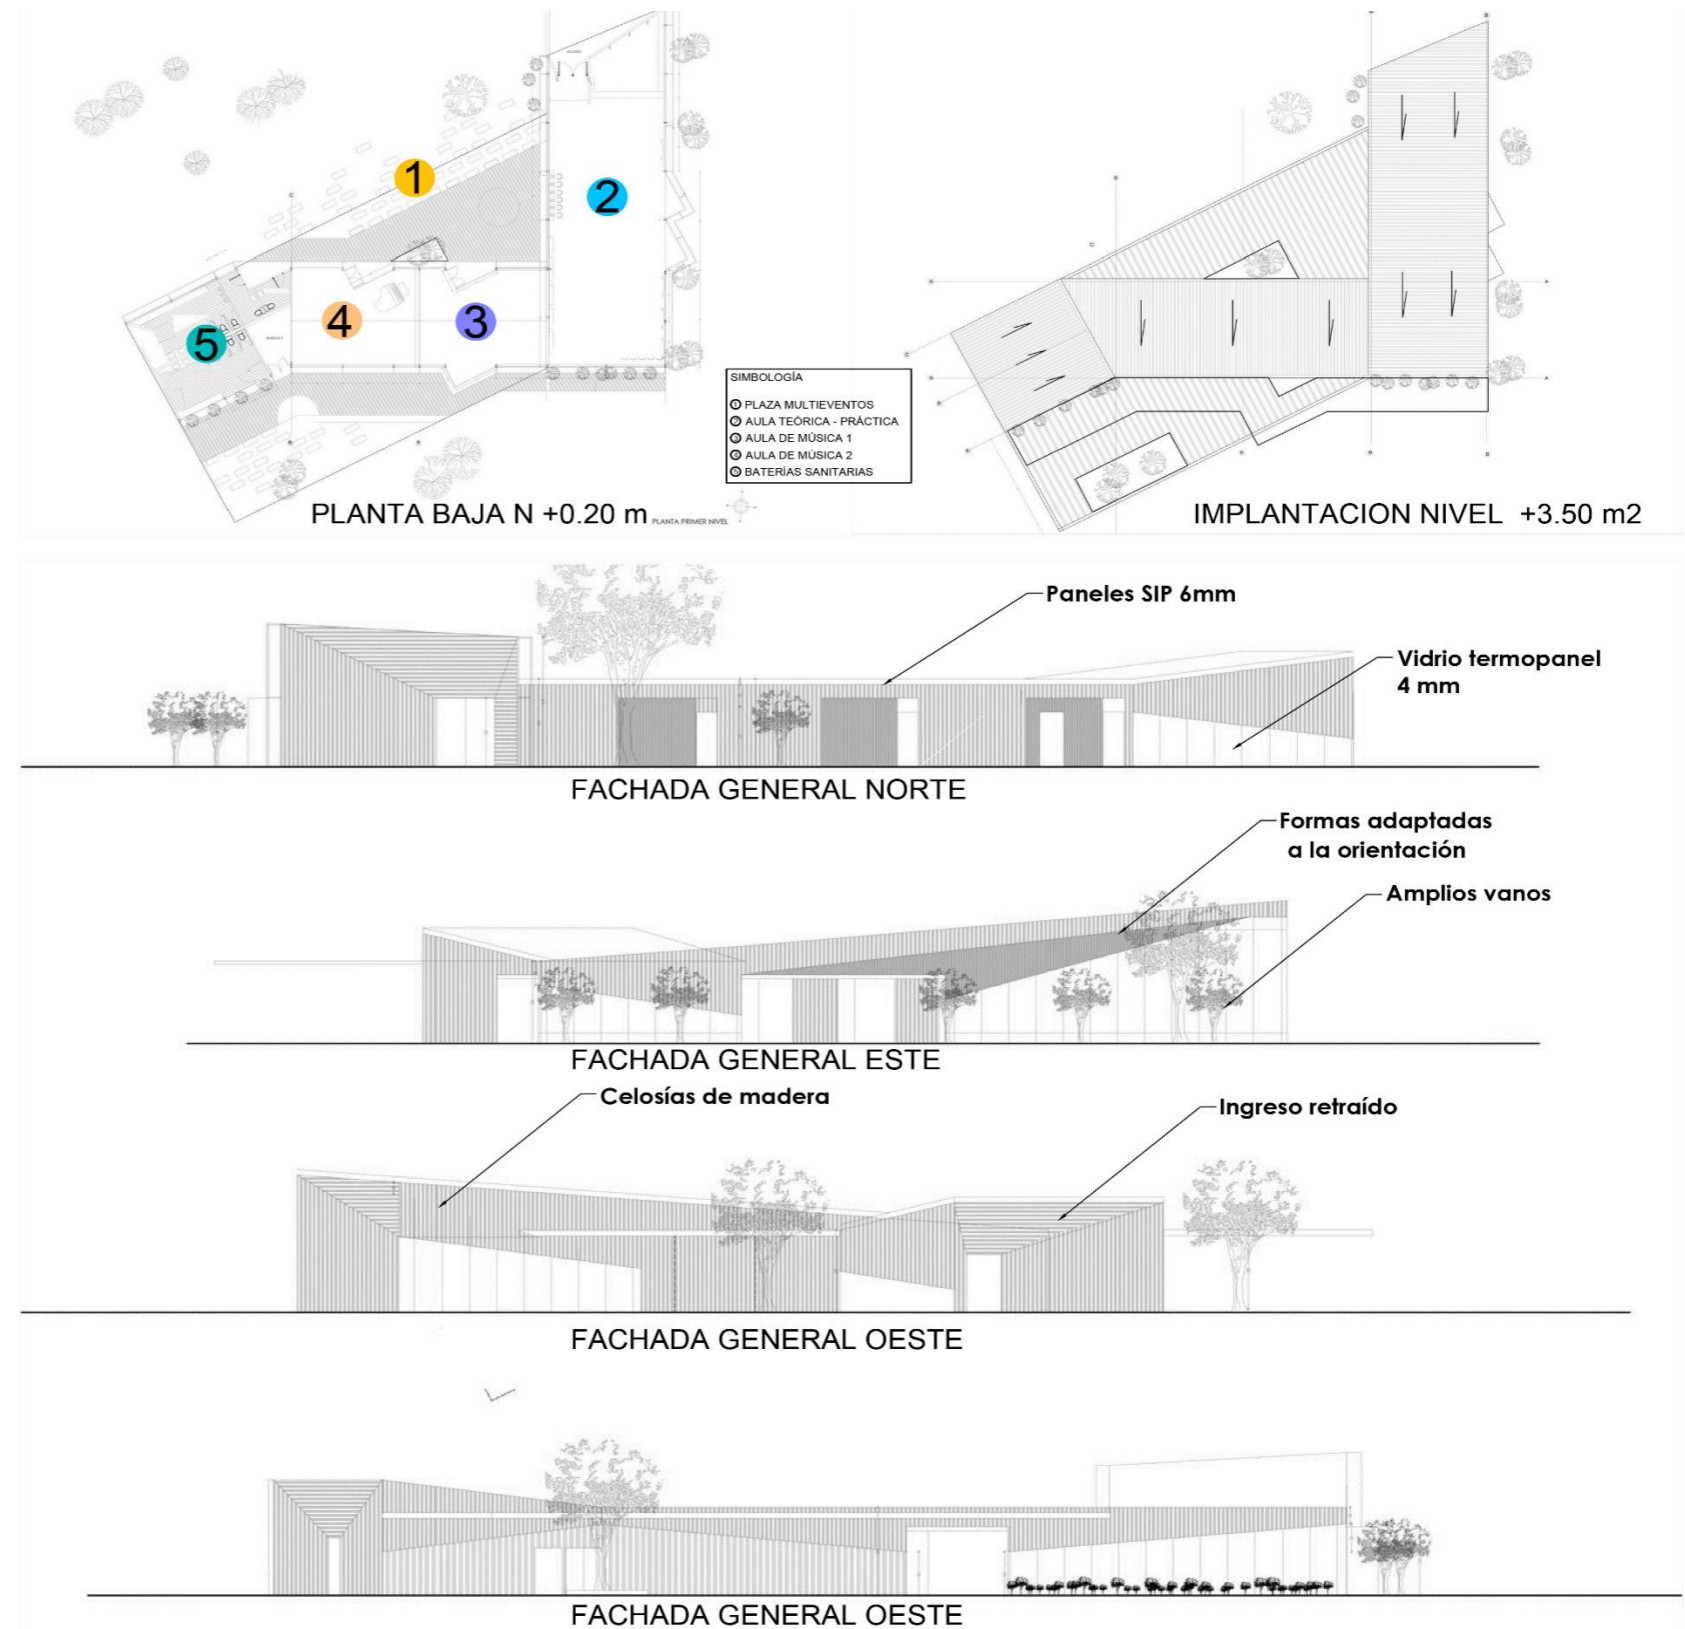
Plantas y fachadas del centro cultural FurmanHuidobro..
